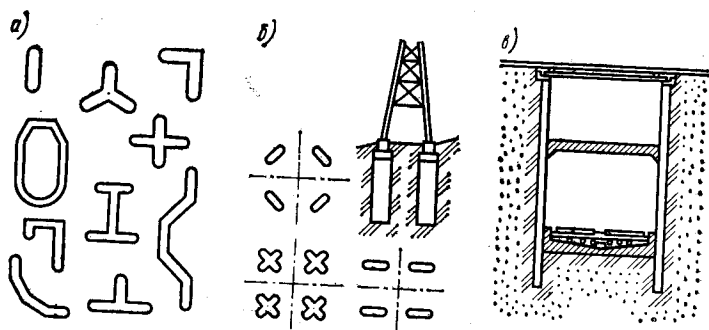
Основные виды конструкций, устраиваемых способом «стена в грунте»:
